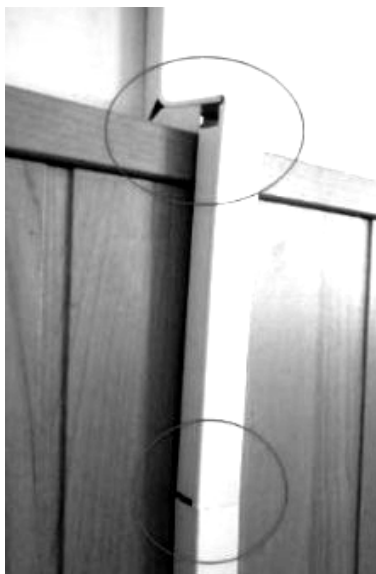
Некачественный монтаж электропроводки в кабель-канале
